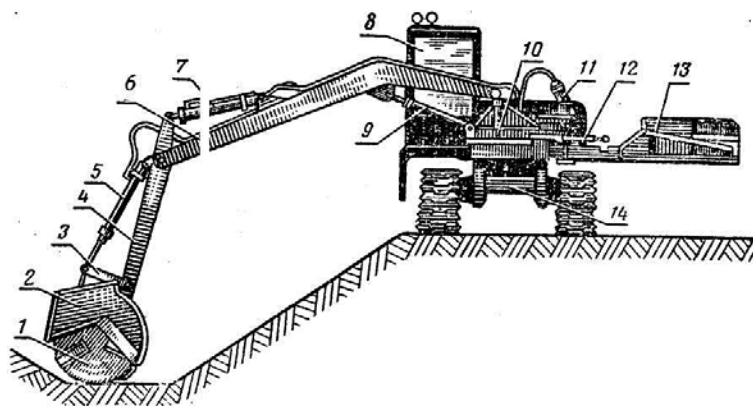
Общий вид многоцелевого каналоочистителя МР-21: 1 – фреза; 2 – кожух; 3 – рычаг; 4 – рукоять; 5, 7, 9, 12 – гидроцилиндры; 6 – стрела; 8 – кабина; 10 – поворотная платформа; 11 – гидромотор привода поворотной платформы; 13 – противовес; 14 – ходовое устройство
